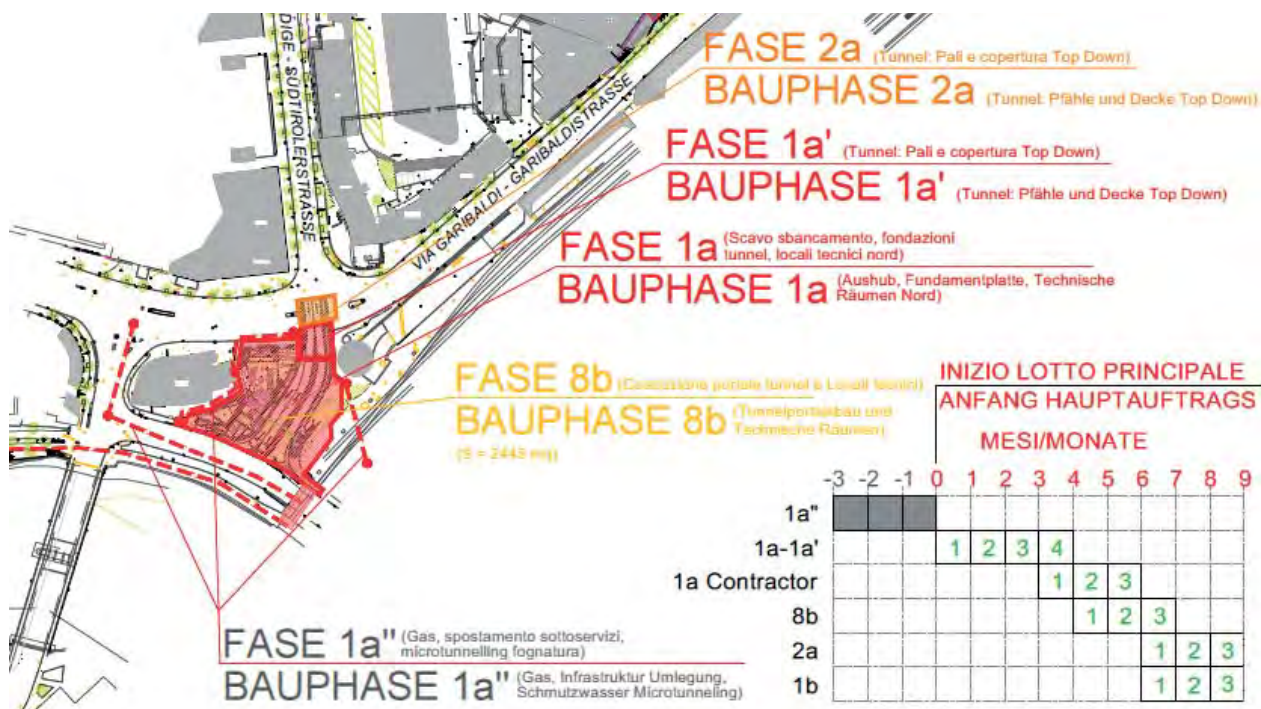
esempio fase di costruzione del progetto di infrastrutture
